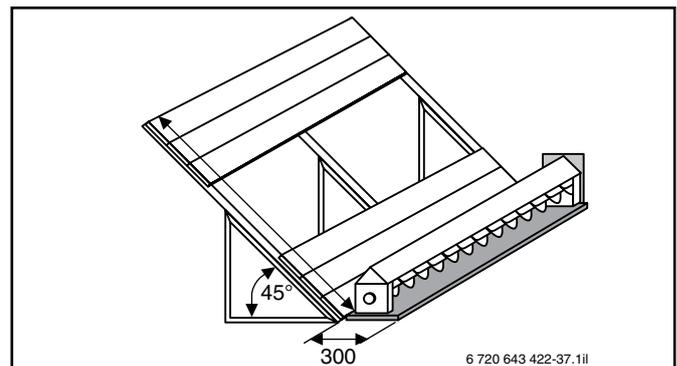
Montaggio della vite al pavimento su una tavola di legno (quote in mm)
